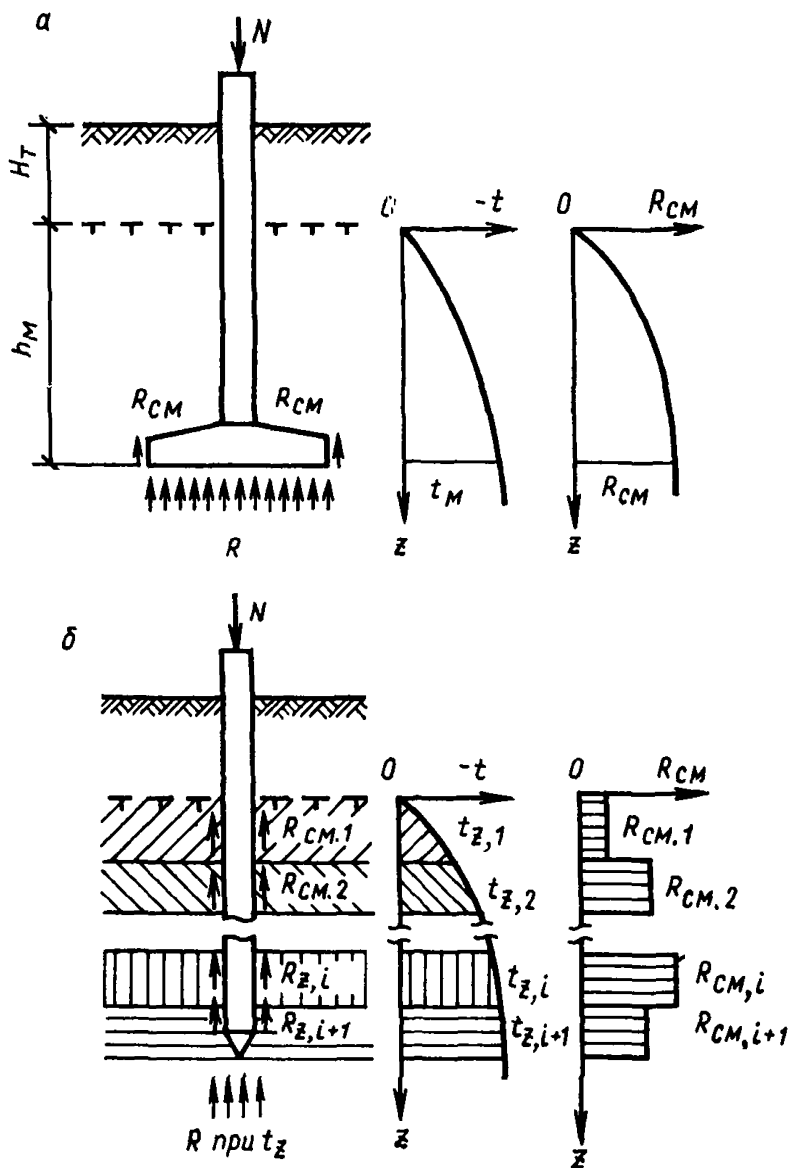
Расчетная схема фундаментов под воздействием вертикальной нагрузки
